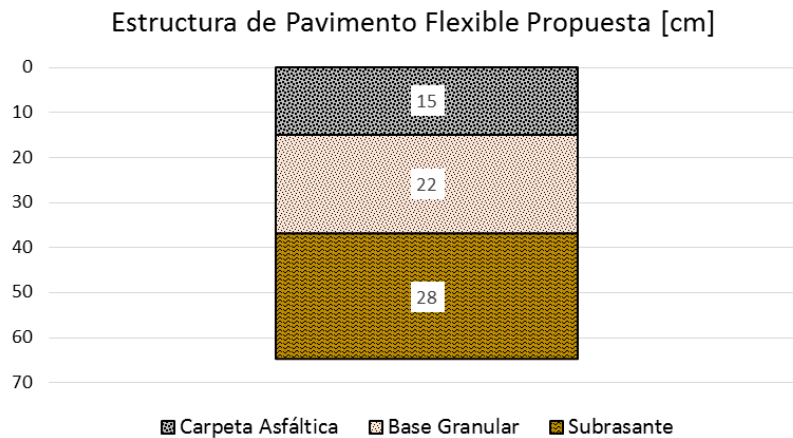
Estructura de Pavimento Flexible Propuesta
